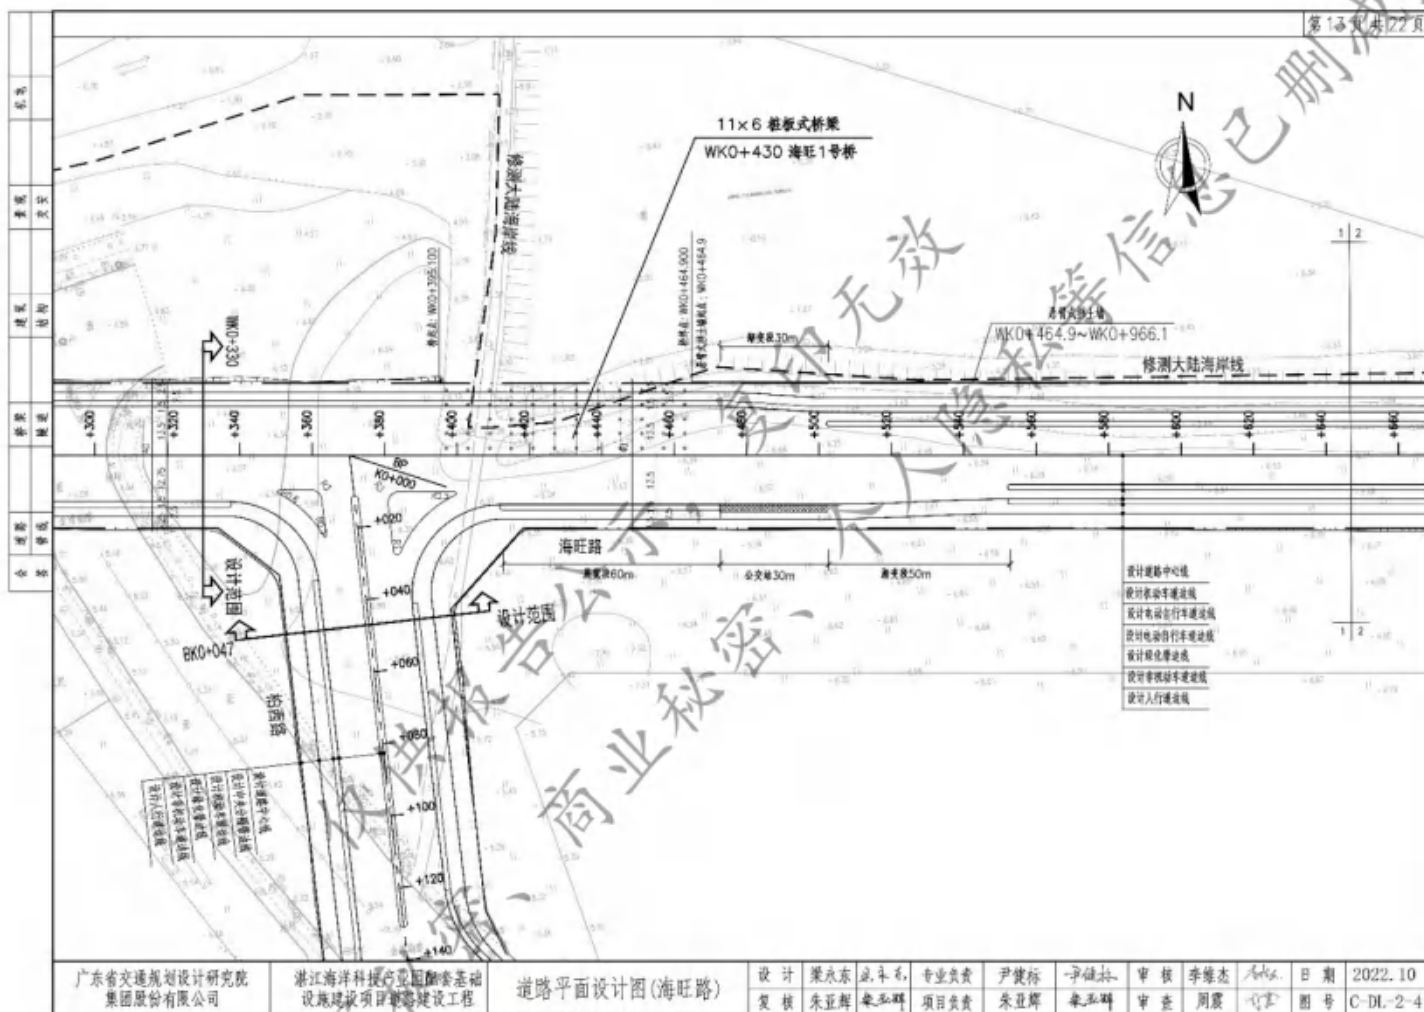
海旺路 1 号桥总平面布置图 (2)
